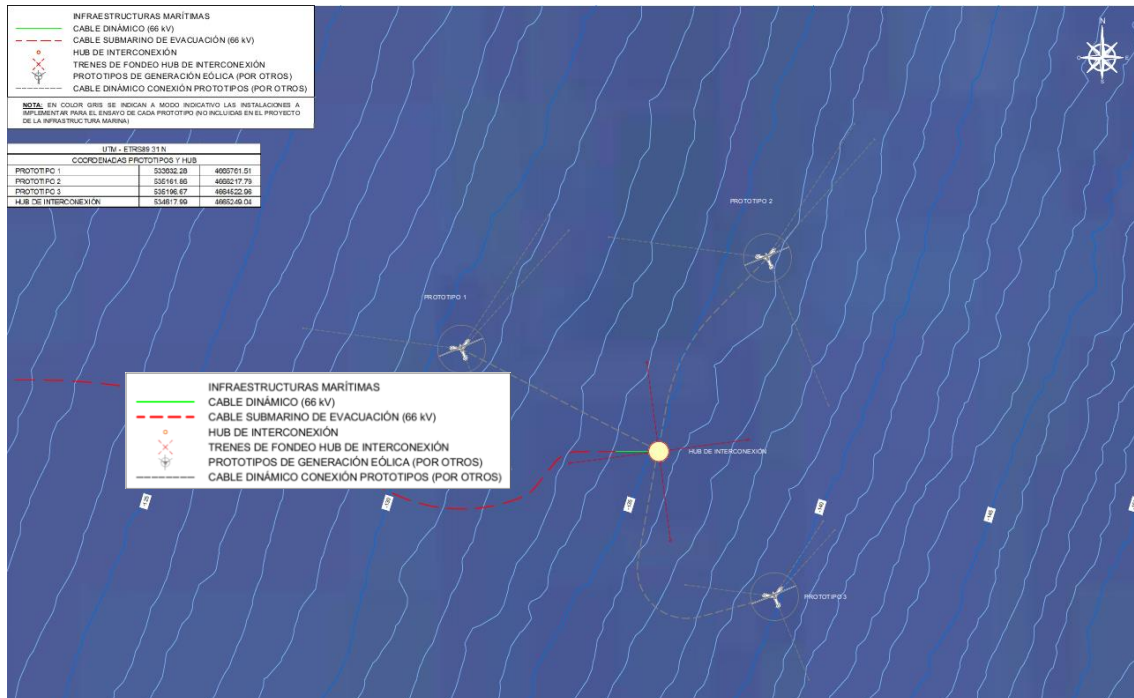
Forma en planta general de la zona de instalación de dispositivos.
